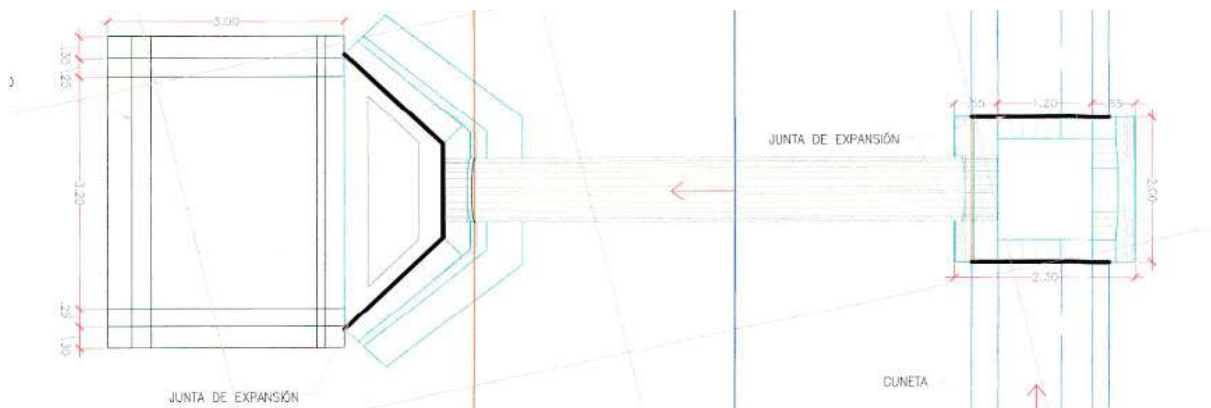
Sentido de flujo de la alcantarilla proyectada 22+750 en el plano de Alcantarillas
